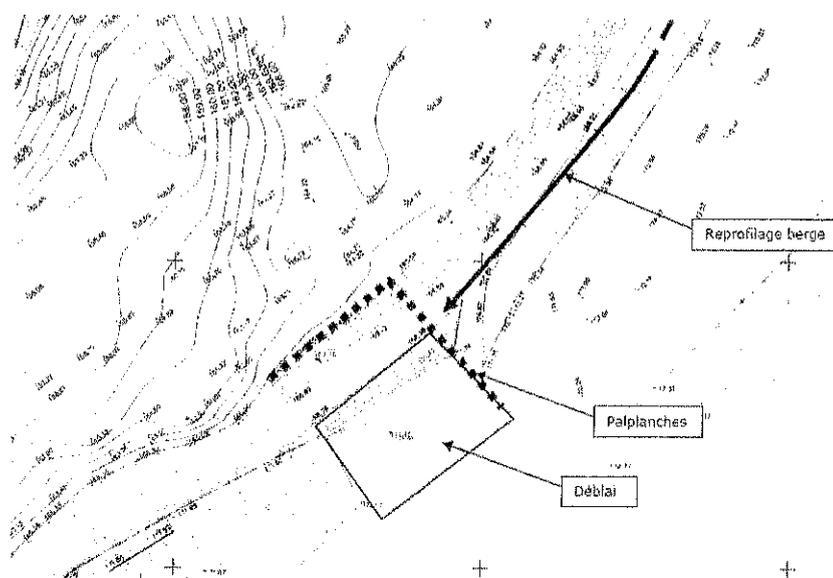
PROTECTION DE BERGE AU DROIT DE LA STATION D'ALERTE (PLAN MASSE)
